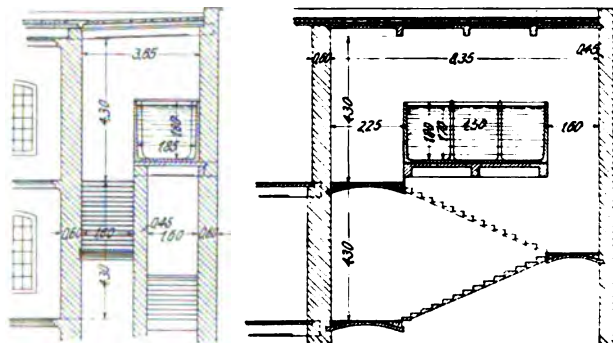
Behälter im Stiegenhaus der Papierfabrik
